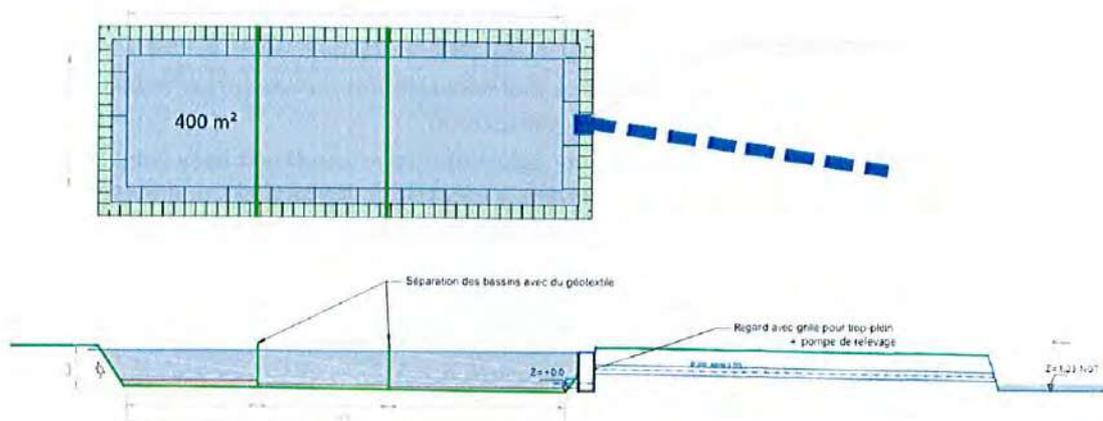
Vue en plan et coupe du bassin de décantation pendant le terrassement
